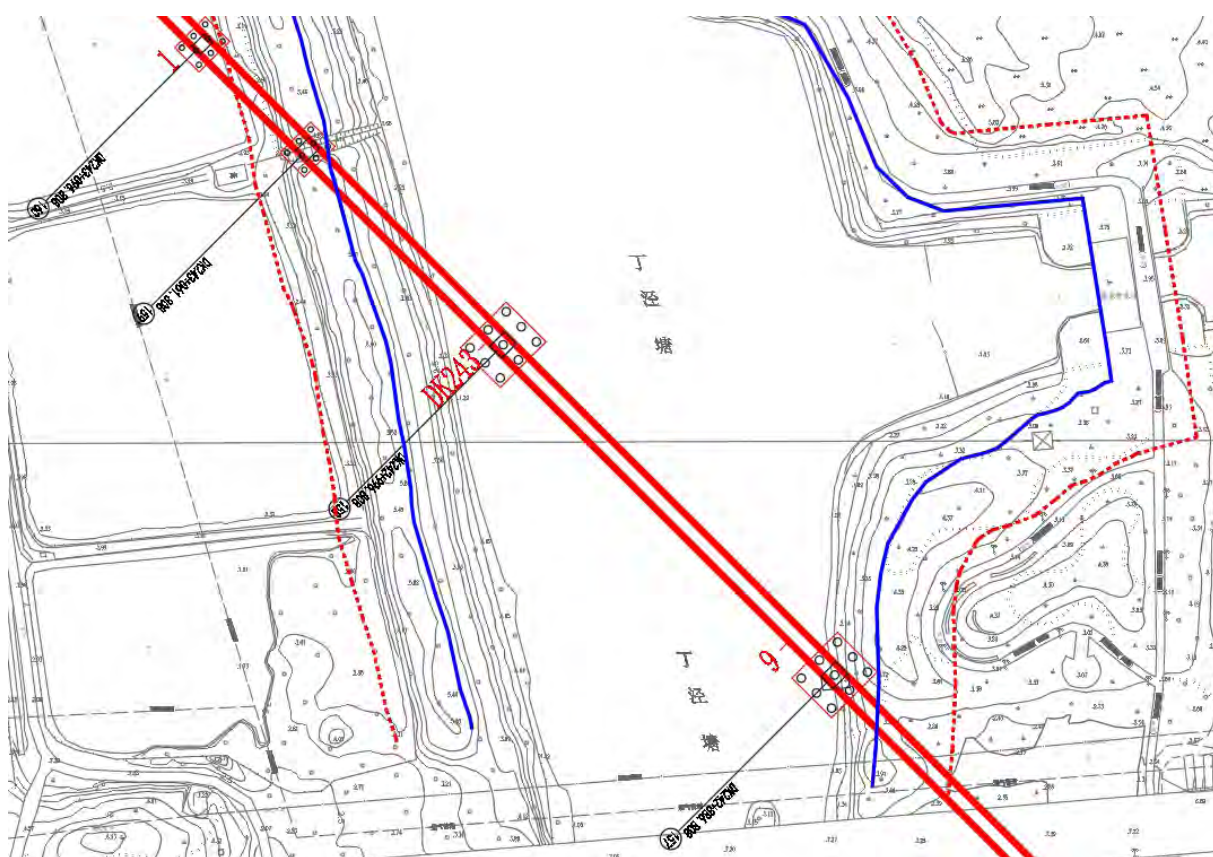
跨沪苏湖特大桥跨丁泾塘桥梁平面布置图
